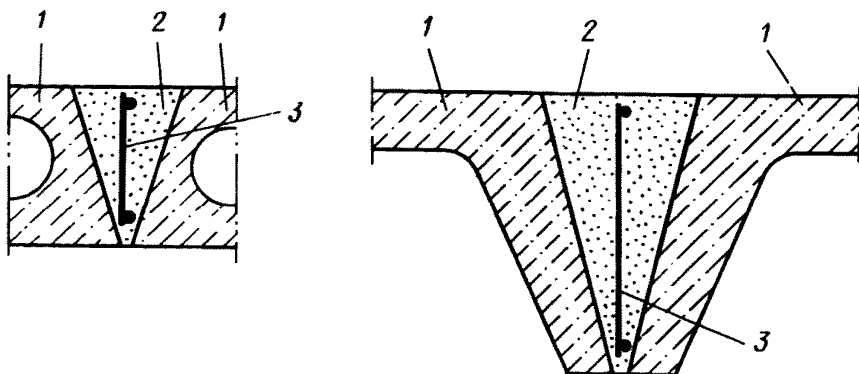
Усиление сборных железобетонных перекрытий армированием стыков
